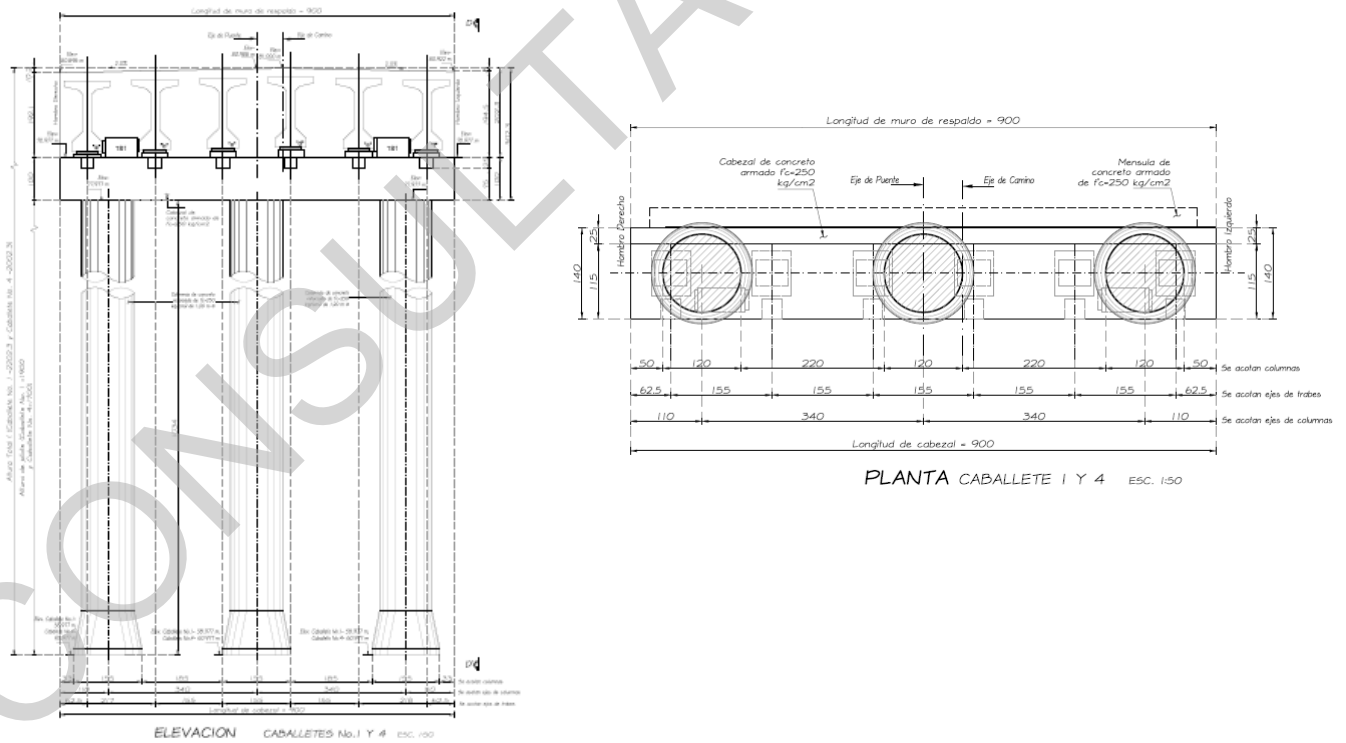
Planta, elevación del caballete 1 y 4 (pilote).
